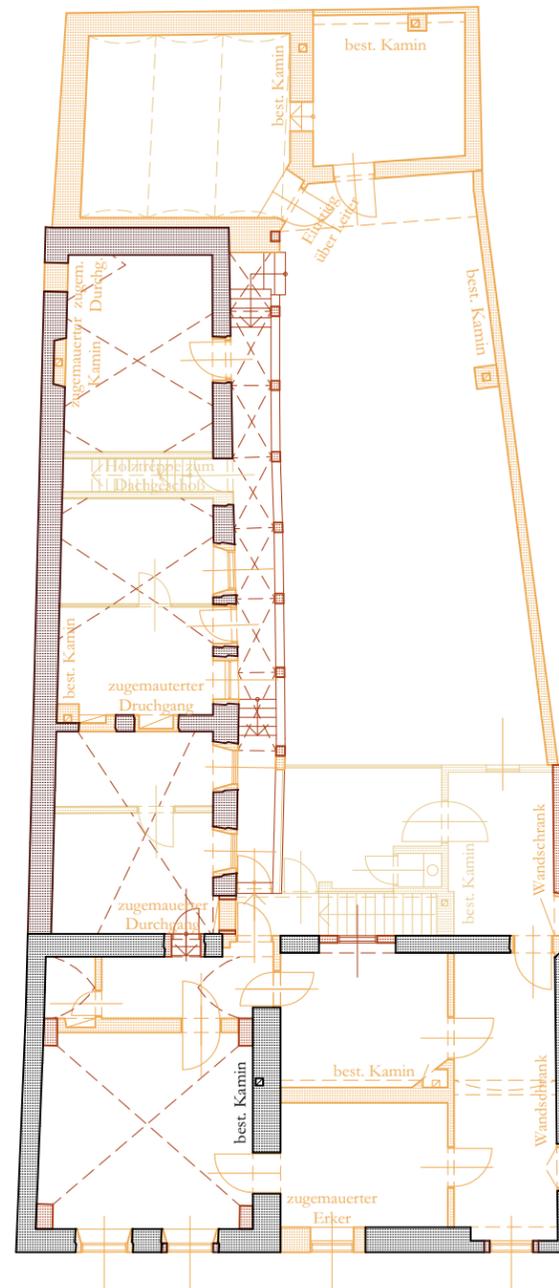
Baualtersplan 1. Obergeschoß, M 1:200
